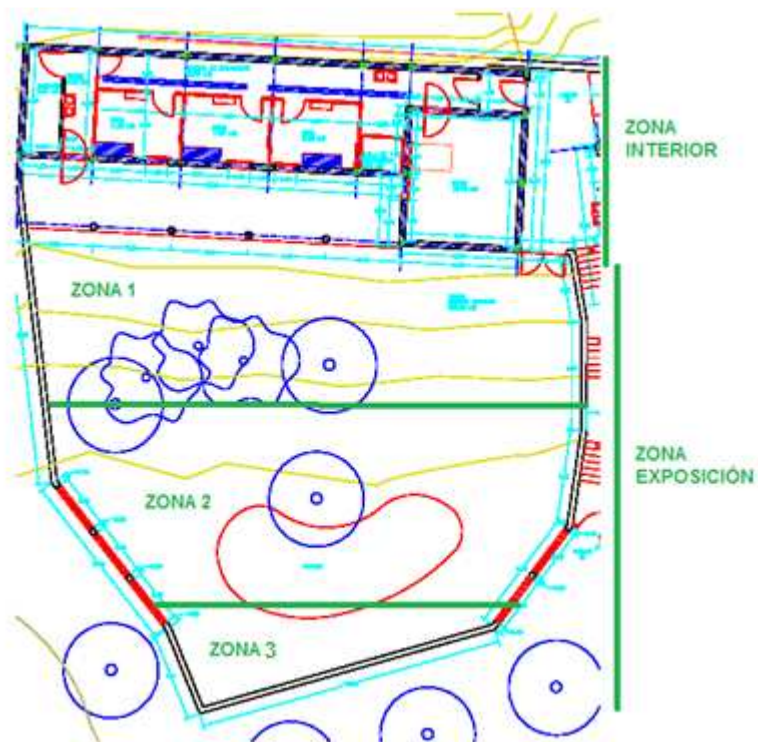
Plano instalación tigres dividido en las zonas de estudio.
